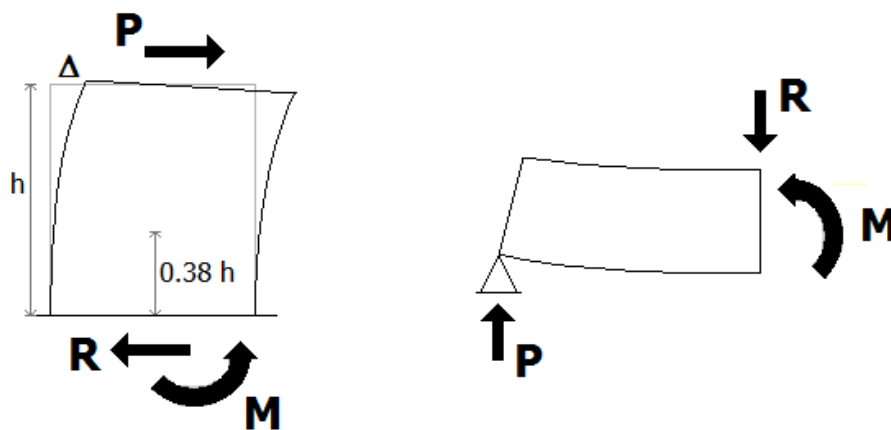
Similitud entre zona de corte en viga y muro cantilever.
